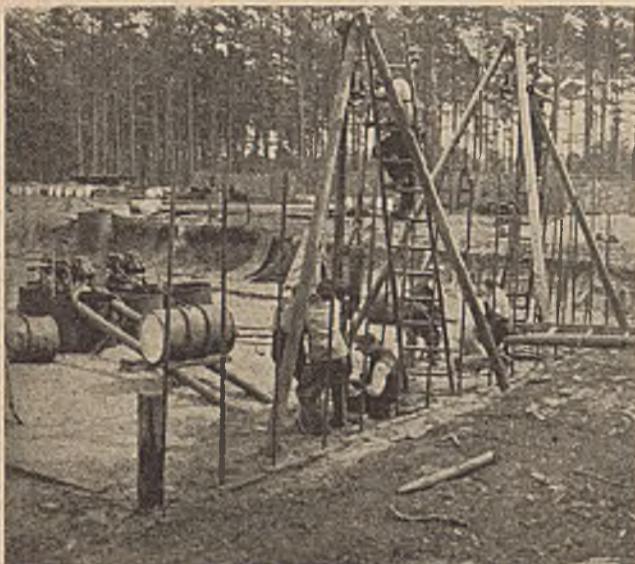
Pumpenhaus Berkhof des Wasserwerks Hannover, Verfestigungsanlage. Einrammen der Spritzrohre vor der Schmalseite der von Spundwänden umschlossenen Baugrube.
